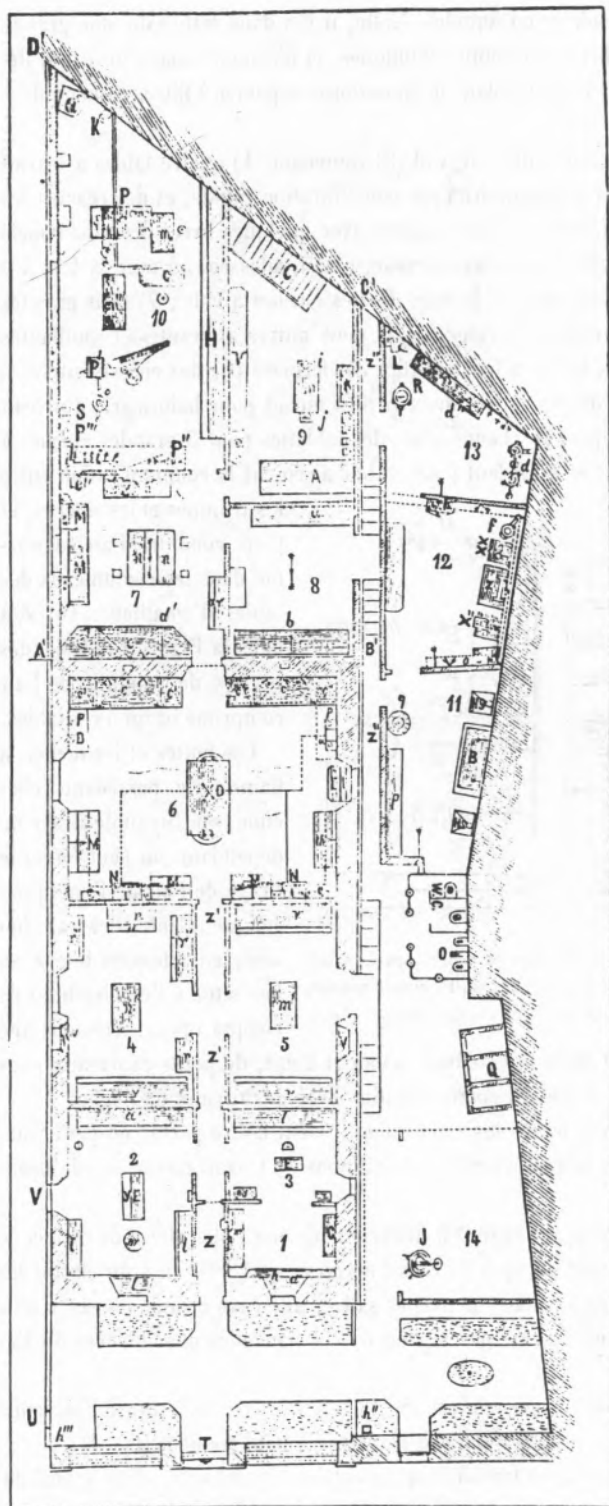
Plan du Laboratoire (Échelle de 1/200)
